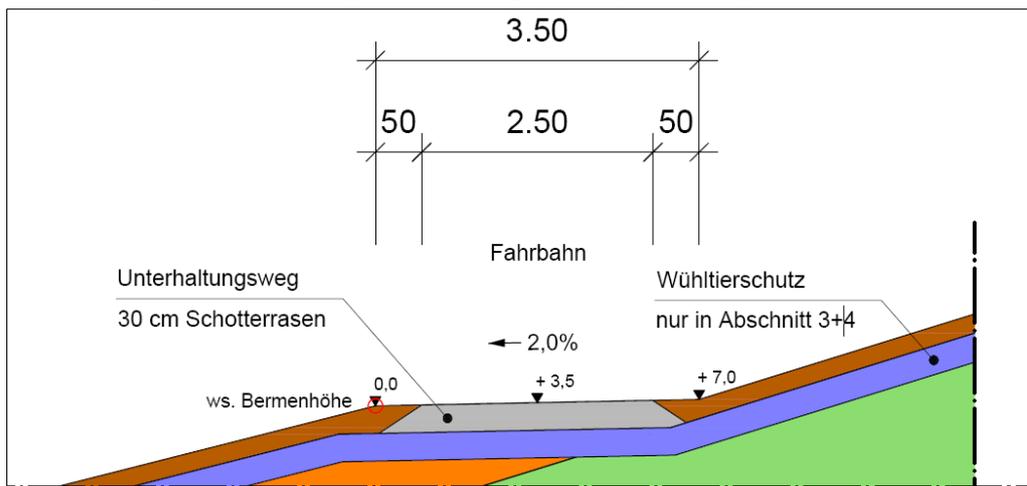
Regelprofil wasserseitige Unterhaltungsberme (Ausschnitte der Plandarstellung)
